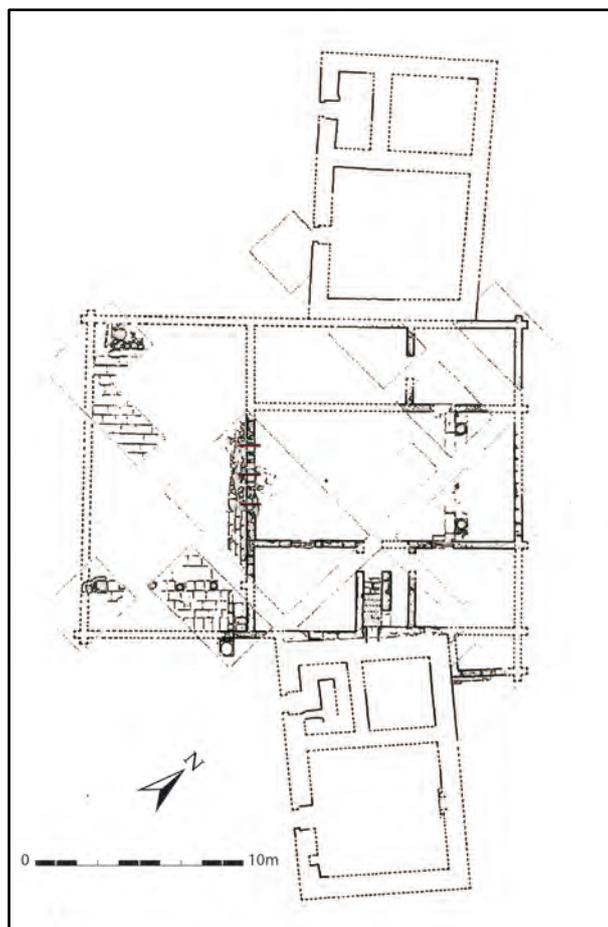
Abu Mina: planimetria della cosiddetta “*Nordliche Säulenhofhaus*”
